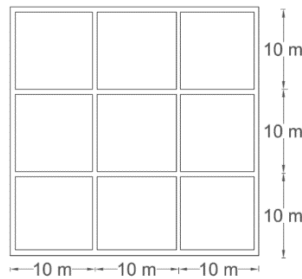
Vista planta de los edificios de 8, 12 y 16 niveles
